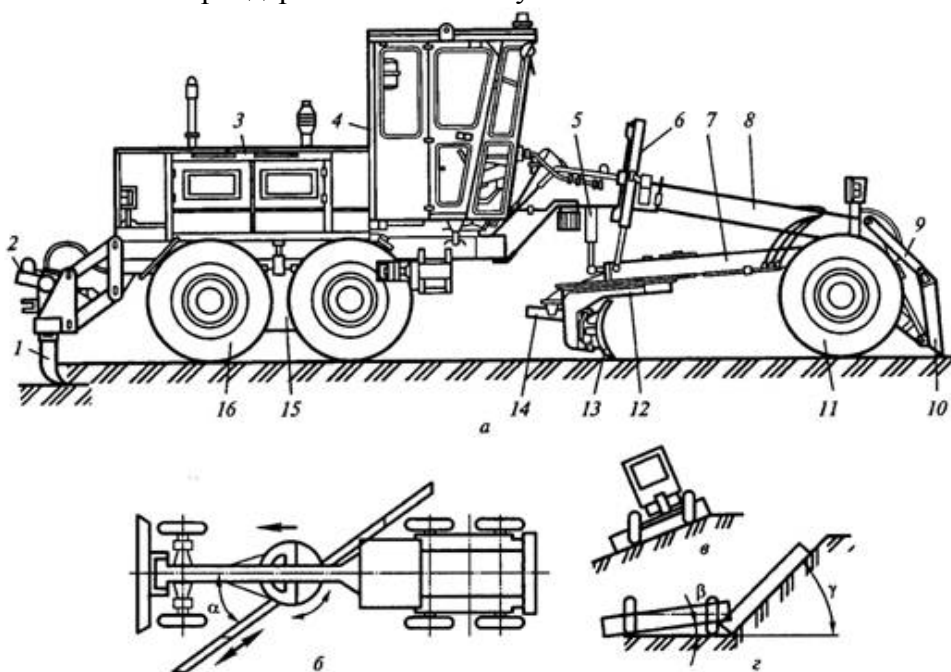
Автогрейдер класса 140: а - общий вид; б - схема поворота отвала в плане; в - схема бокового наклона колес; г - схема бокового выноса отвала.
